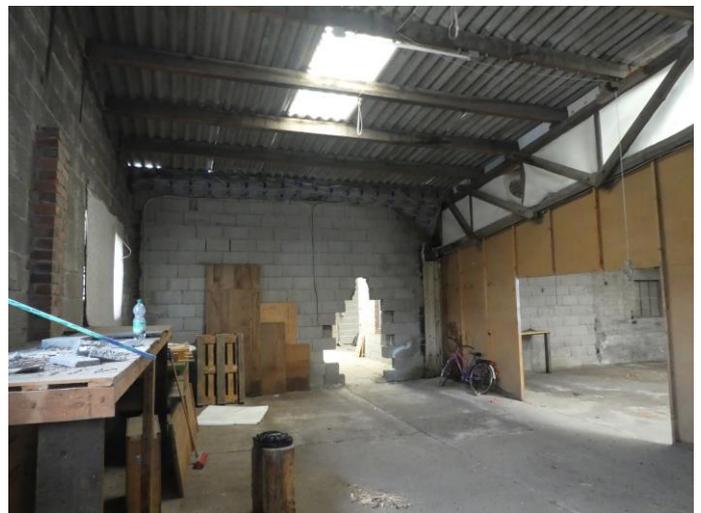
Produktionshalle, Außenwände als Bimssteinmauerwerk
